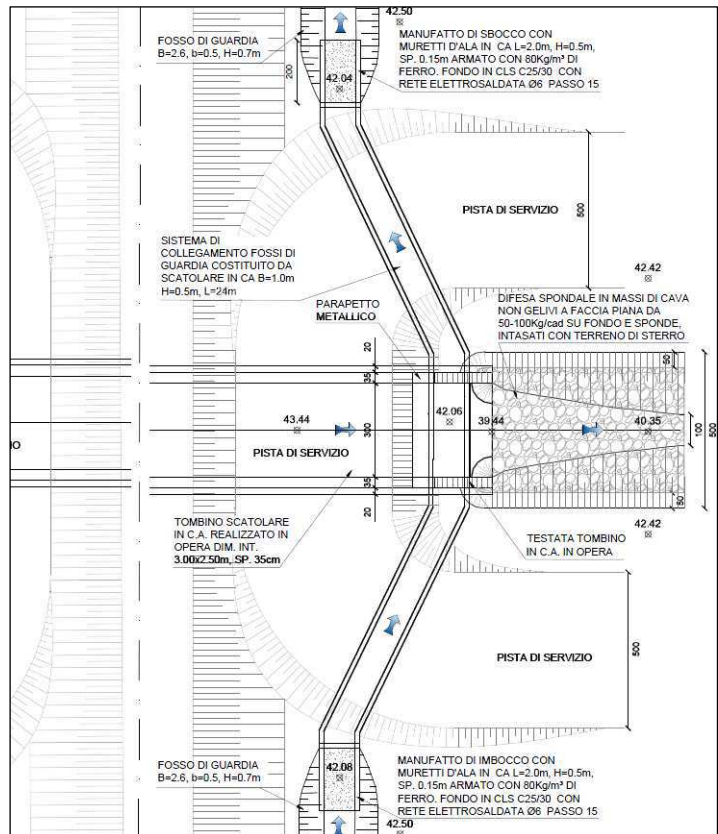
Particolare planimetrico del sovrappasso idraulico della Fossetta Ballanleoche
